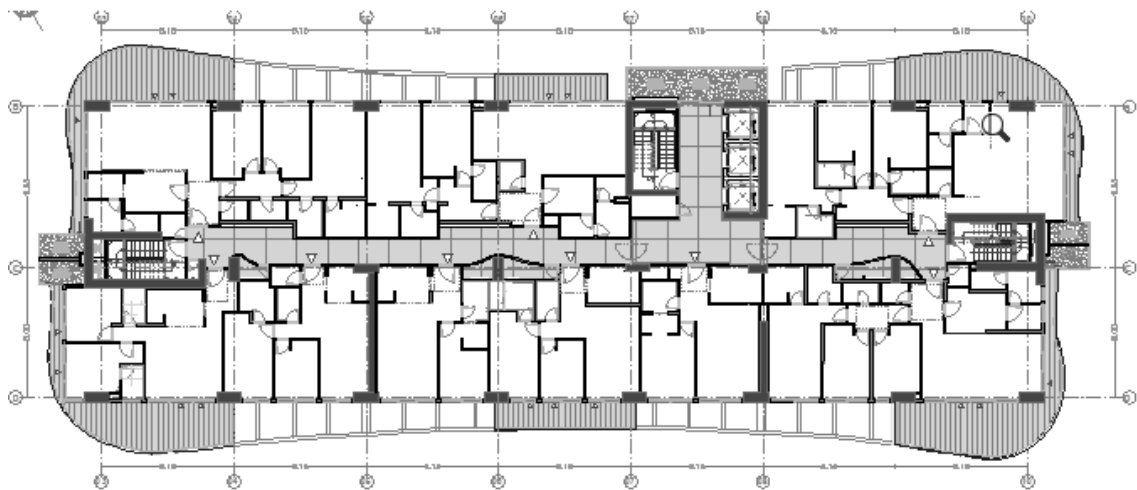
Distribución de columnas, paredes, escaleras y ascensor en piso normal.
